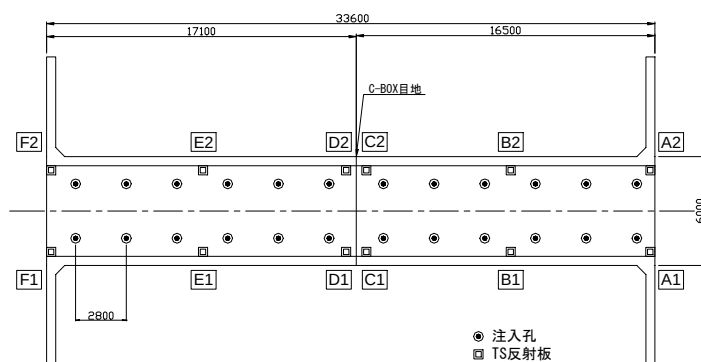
道路 BOX 注入孔及び TS 反射盤設置平面図
